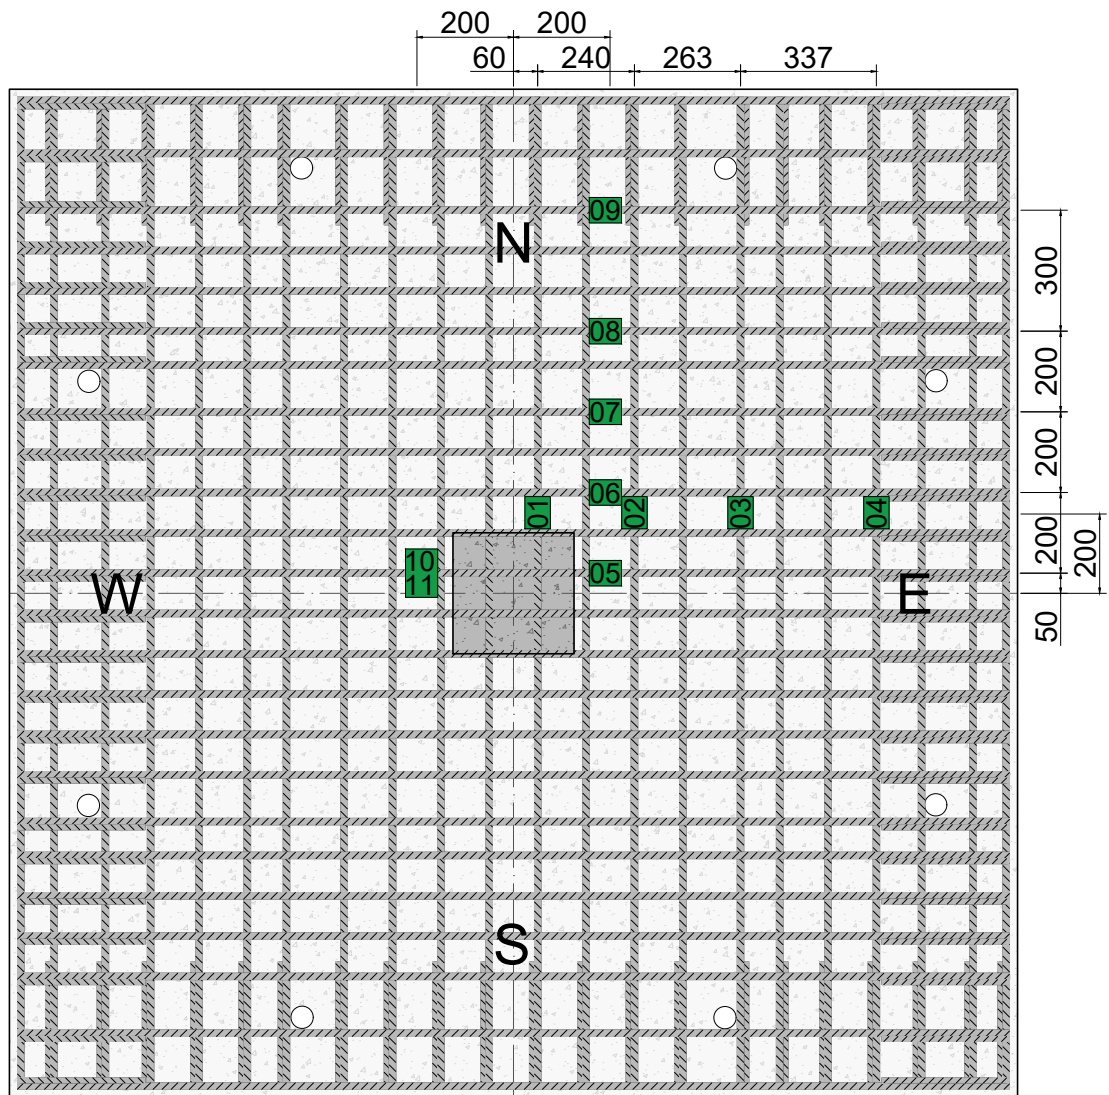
Posicionamento dos extensômetros nas barras de flexão da laje sem aberturas [mm]
